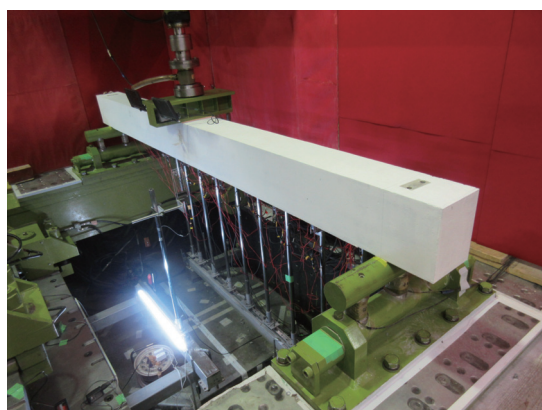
静荷重載荷時の実験装置と試験体の設置状況
